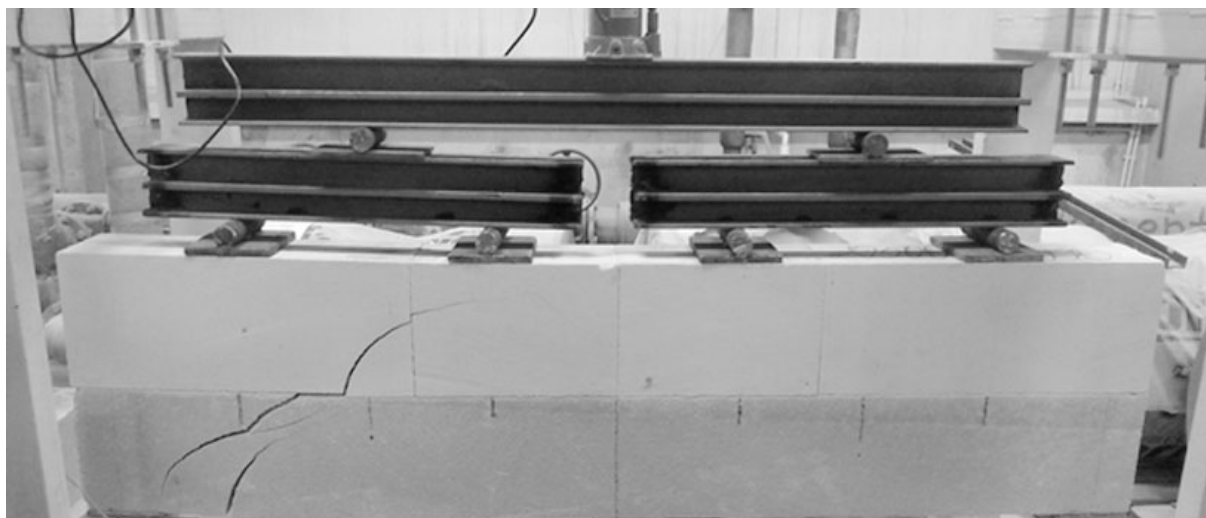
Разрушение армированной ячеистобетонной, испытанной ОАО «Бонолит – Строительные решения», с продергиванием растянутой арматуры
